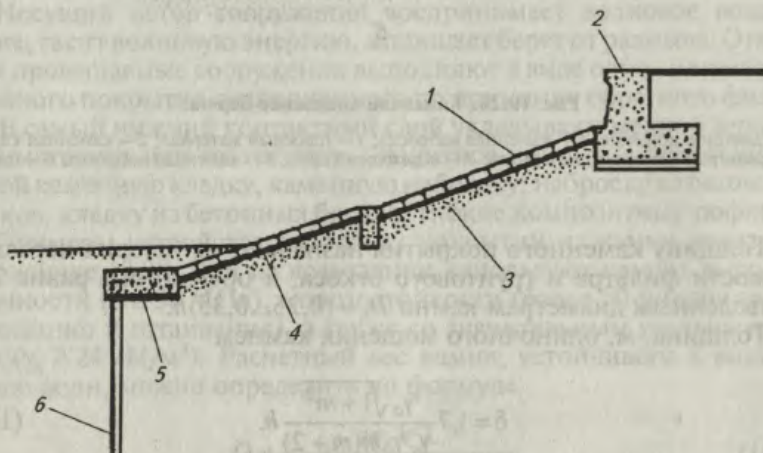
Бетонное крепление из плоских блоков (плит):
